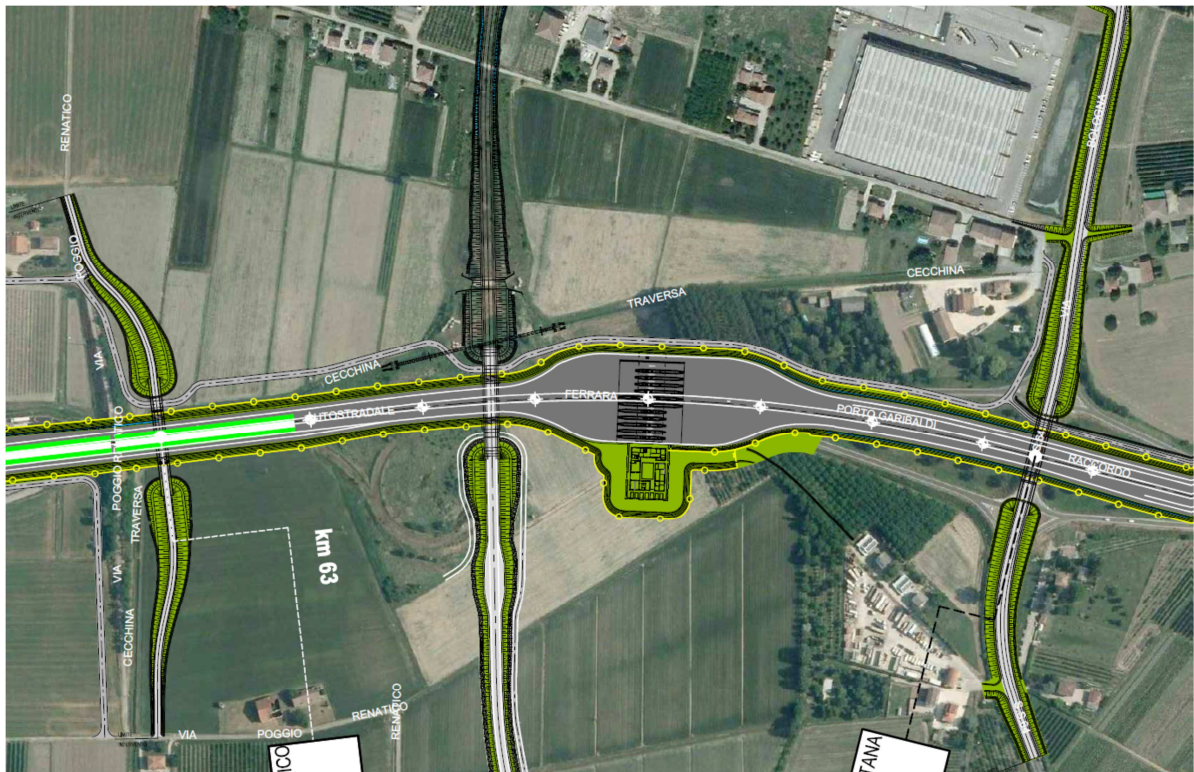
PLANIMETRIA SU ORTOFOTO DELLA STRADA PODERALE IN PROGETTO
